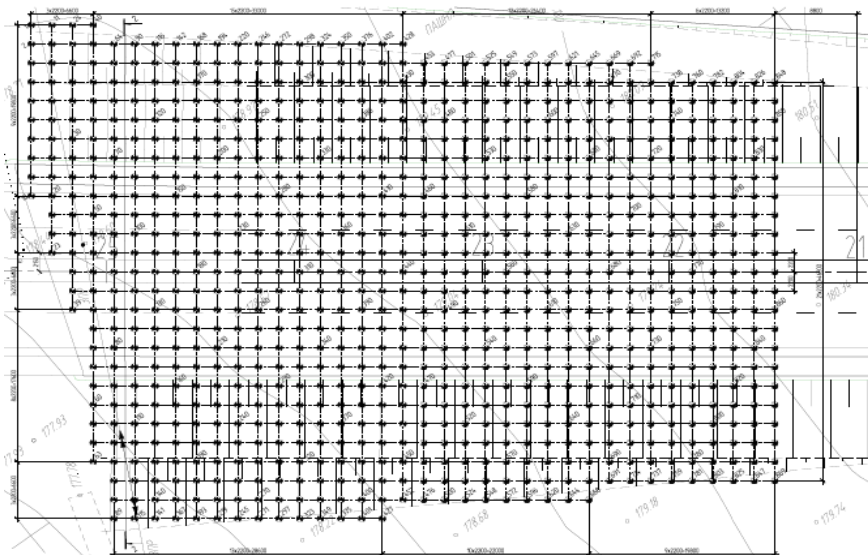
План щебеночных элементов ПК 25+6.02-ПК21
